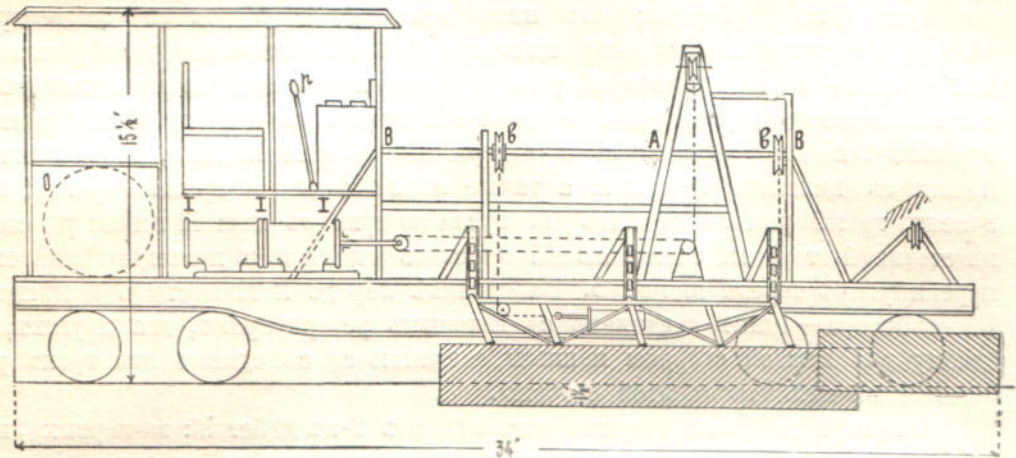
Боковой видъ разравнивателя сильнаго типа.
